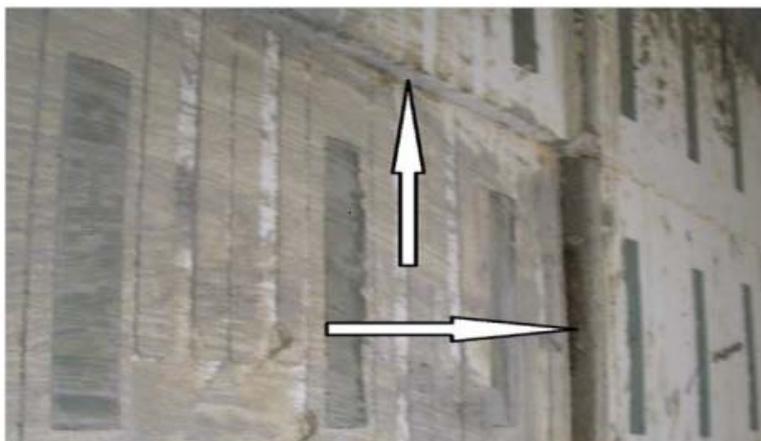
Внешнее повреждение монолитной железобетонной стены из пенополистирольной несъемной опалубки
